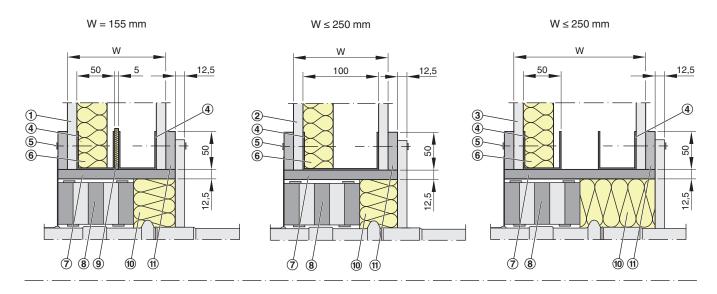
Trockeneinbau in F90-Leichtbauwände mit W ≥ 155 mm (mit Laibung / ohne Laibung)
